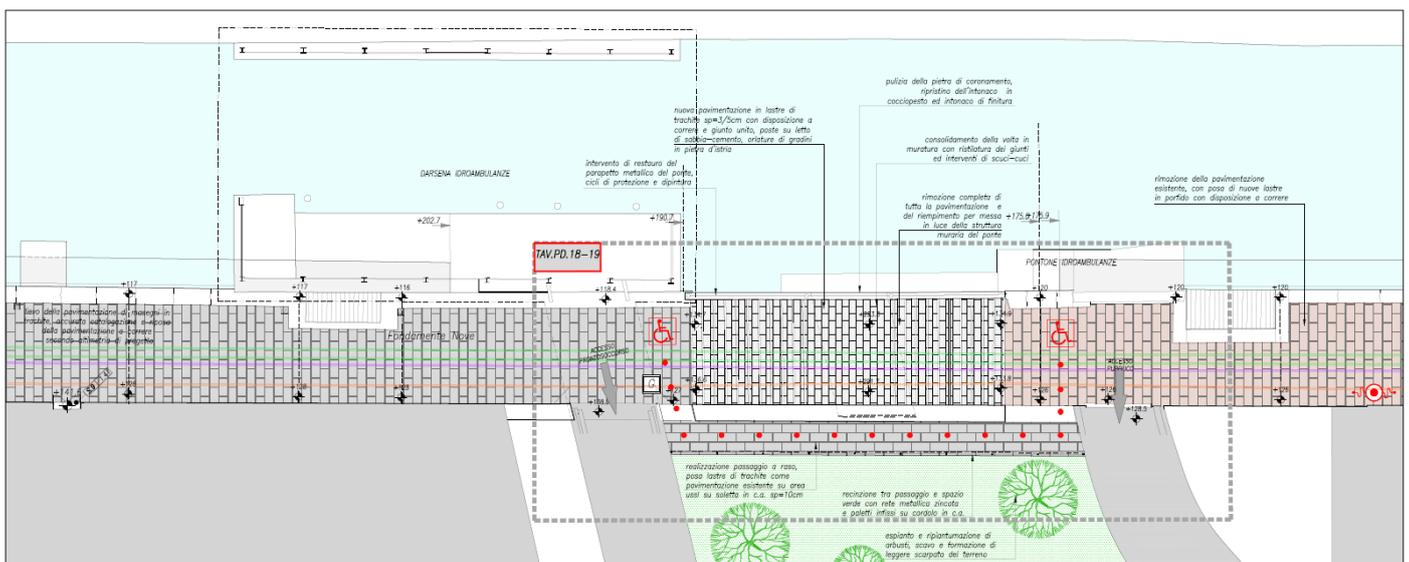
Planimetria di progetto con individuazione del Ponte della Cavana dell’Ospedale, e attigua area verde; evidenziato anche il nuovo percorso con nuovi varchi
